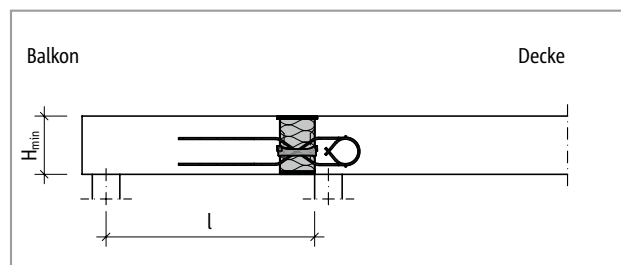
Schöck Isokorb® XT Typ Q-VV: Statisches System (XT Typ Q-VV1 bis VV4)
